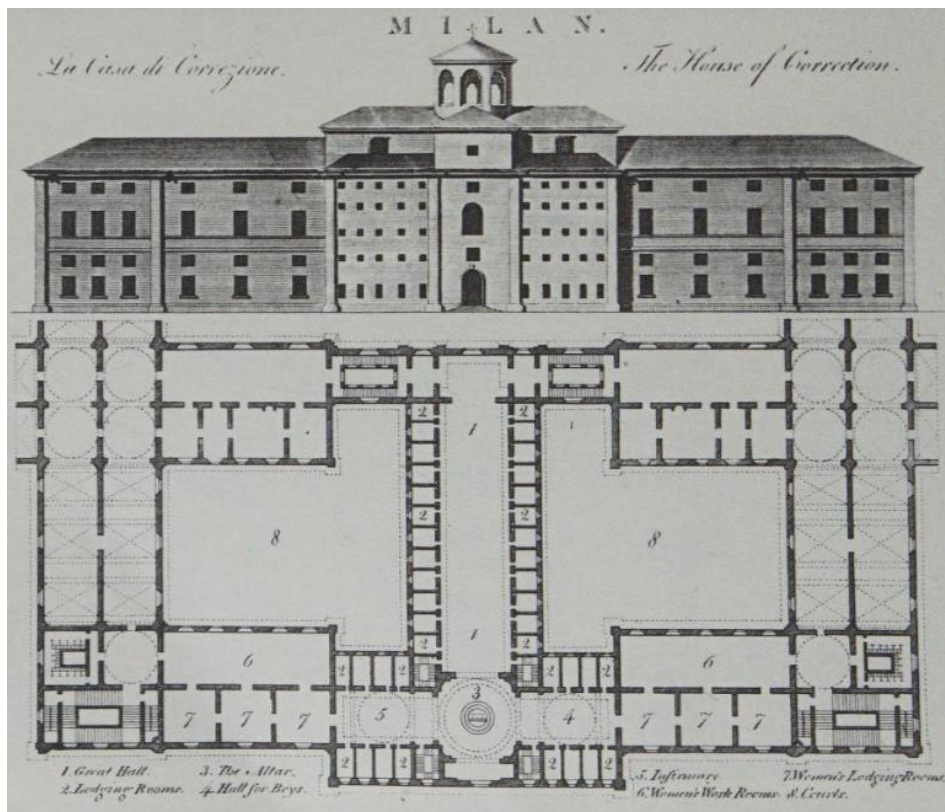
Alçado e planta da Casa de Correção de Milão, séc. XVIII
